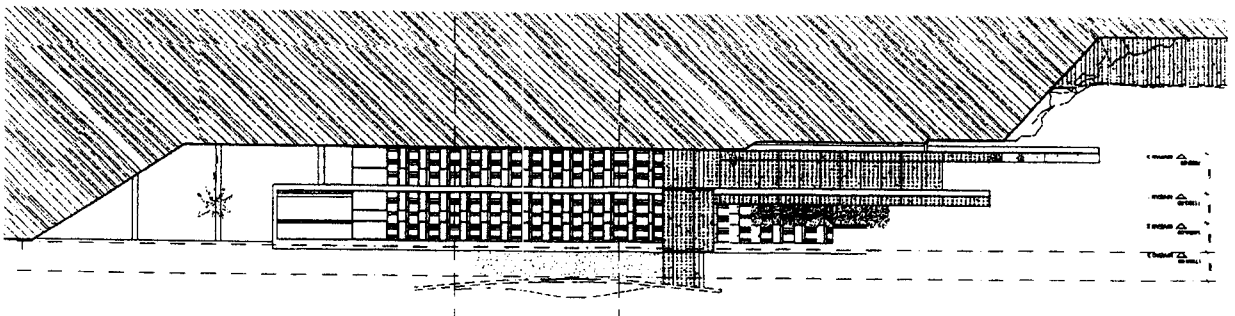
Coupe transversale au niveau de l'aile sud du bâtiment
